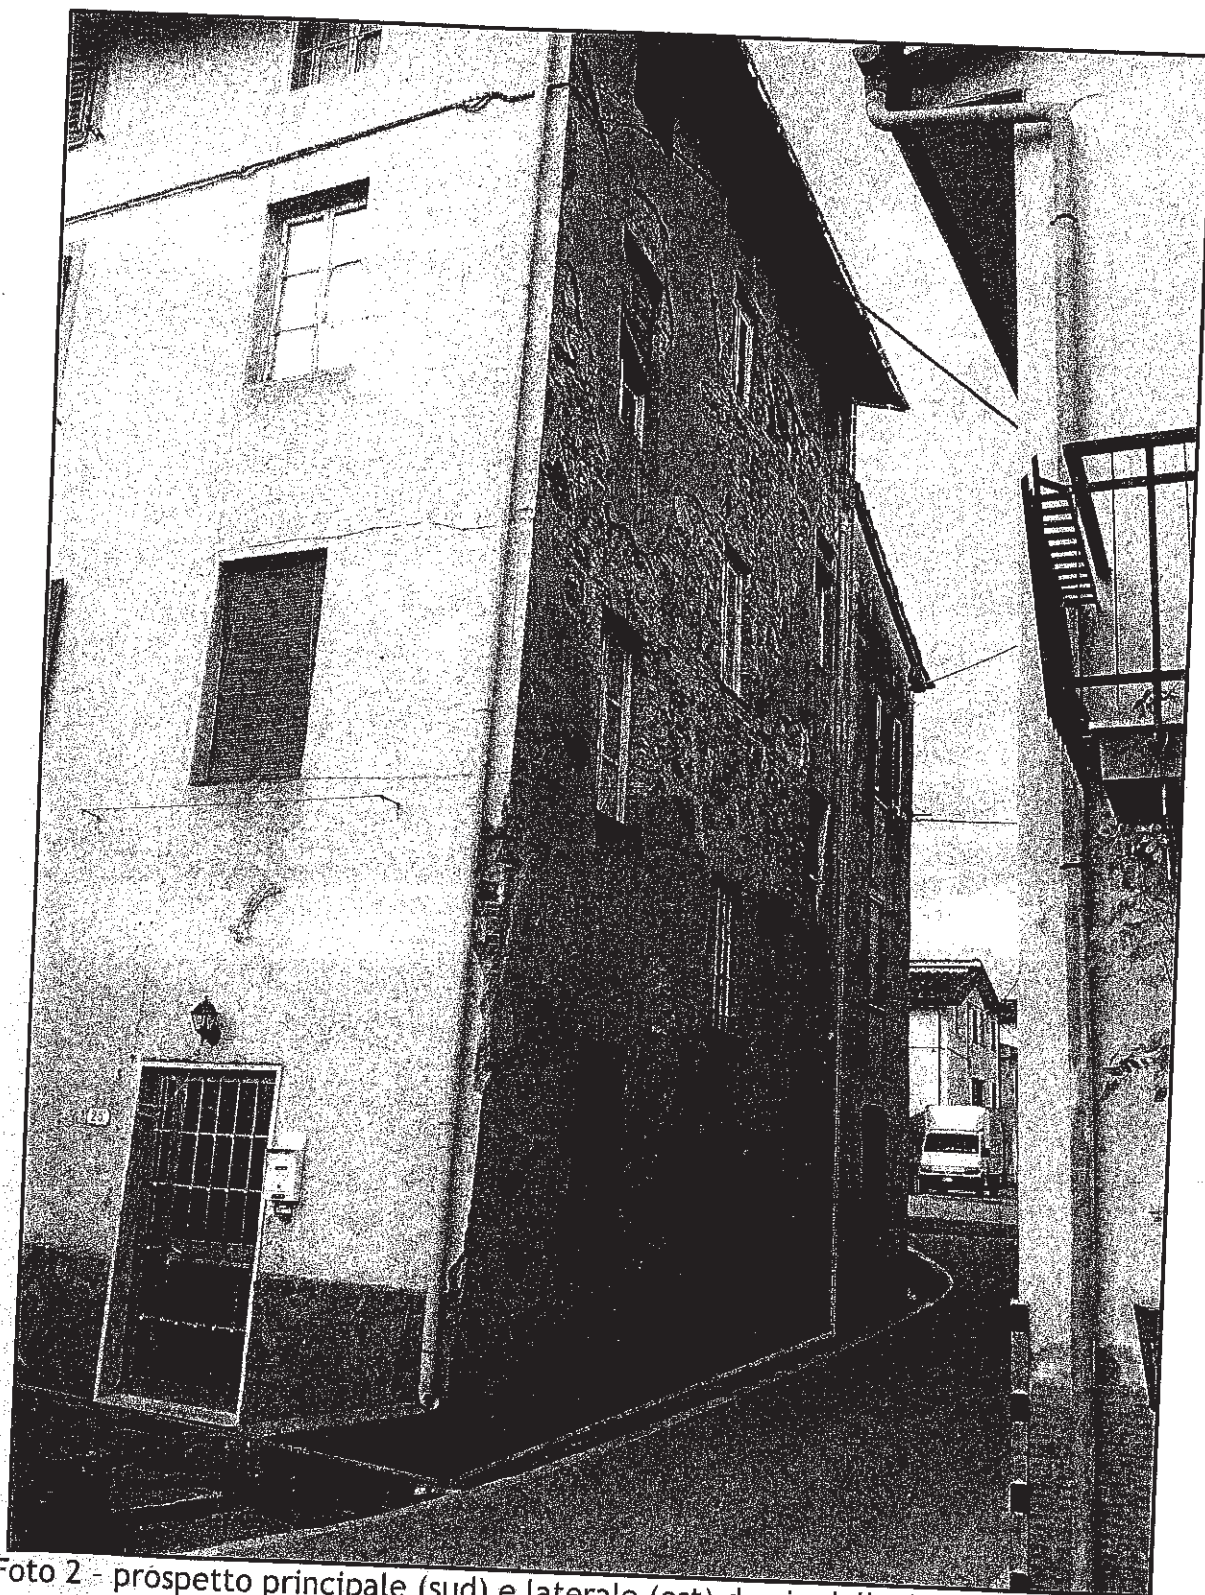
prospetto principale (sud) e laterale (est) da via della Chiesa di S. Angelo
